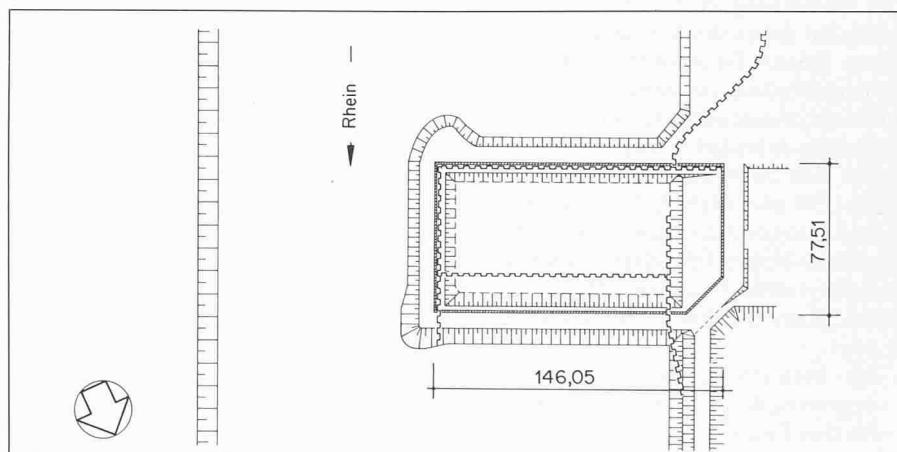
Lageplan mit Baugrube, 1. Bauabschnitt
